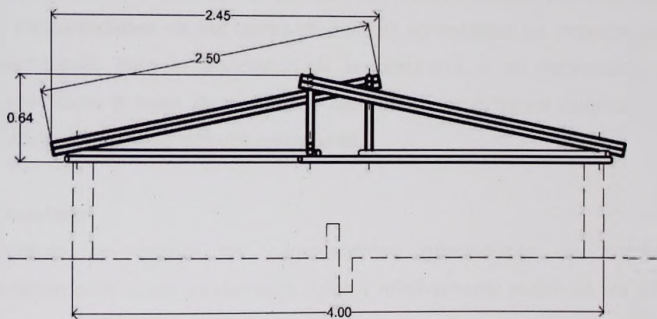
Estructura en Alzado Dibujo: Carlos Uribe
